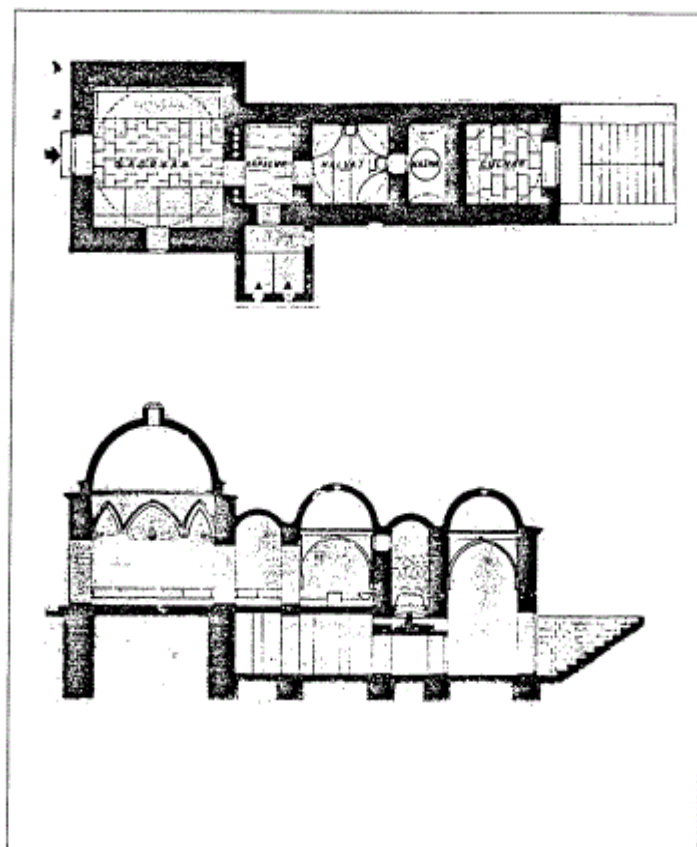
مسقط أفقي وقطاع لحمام غازي خسرو بك في سرايفو (عن: Pašić).
